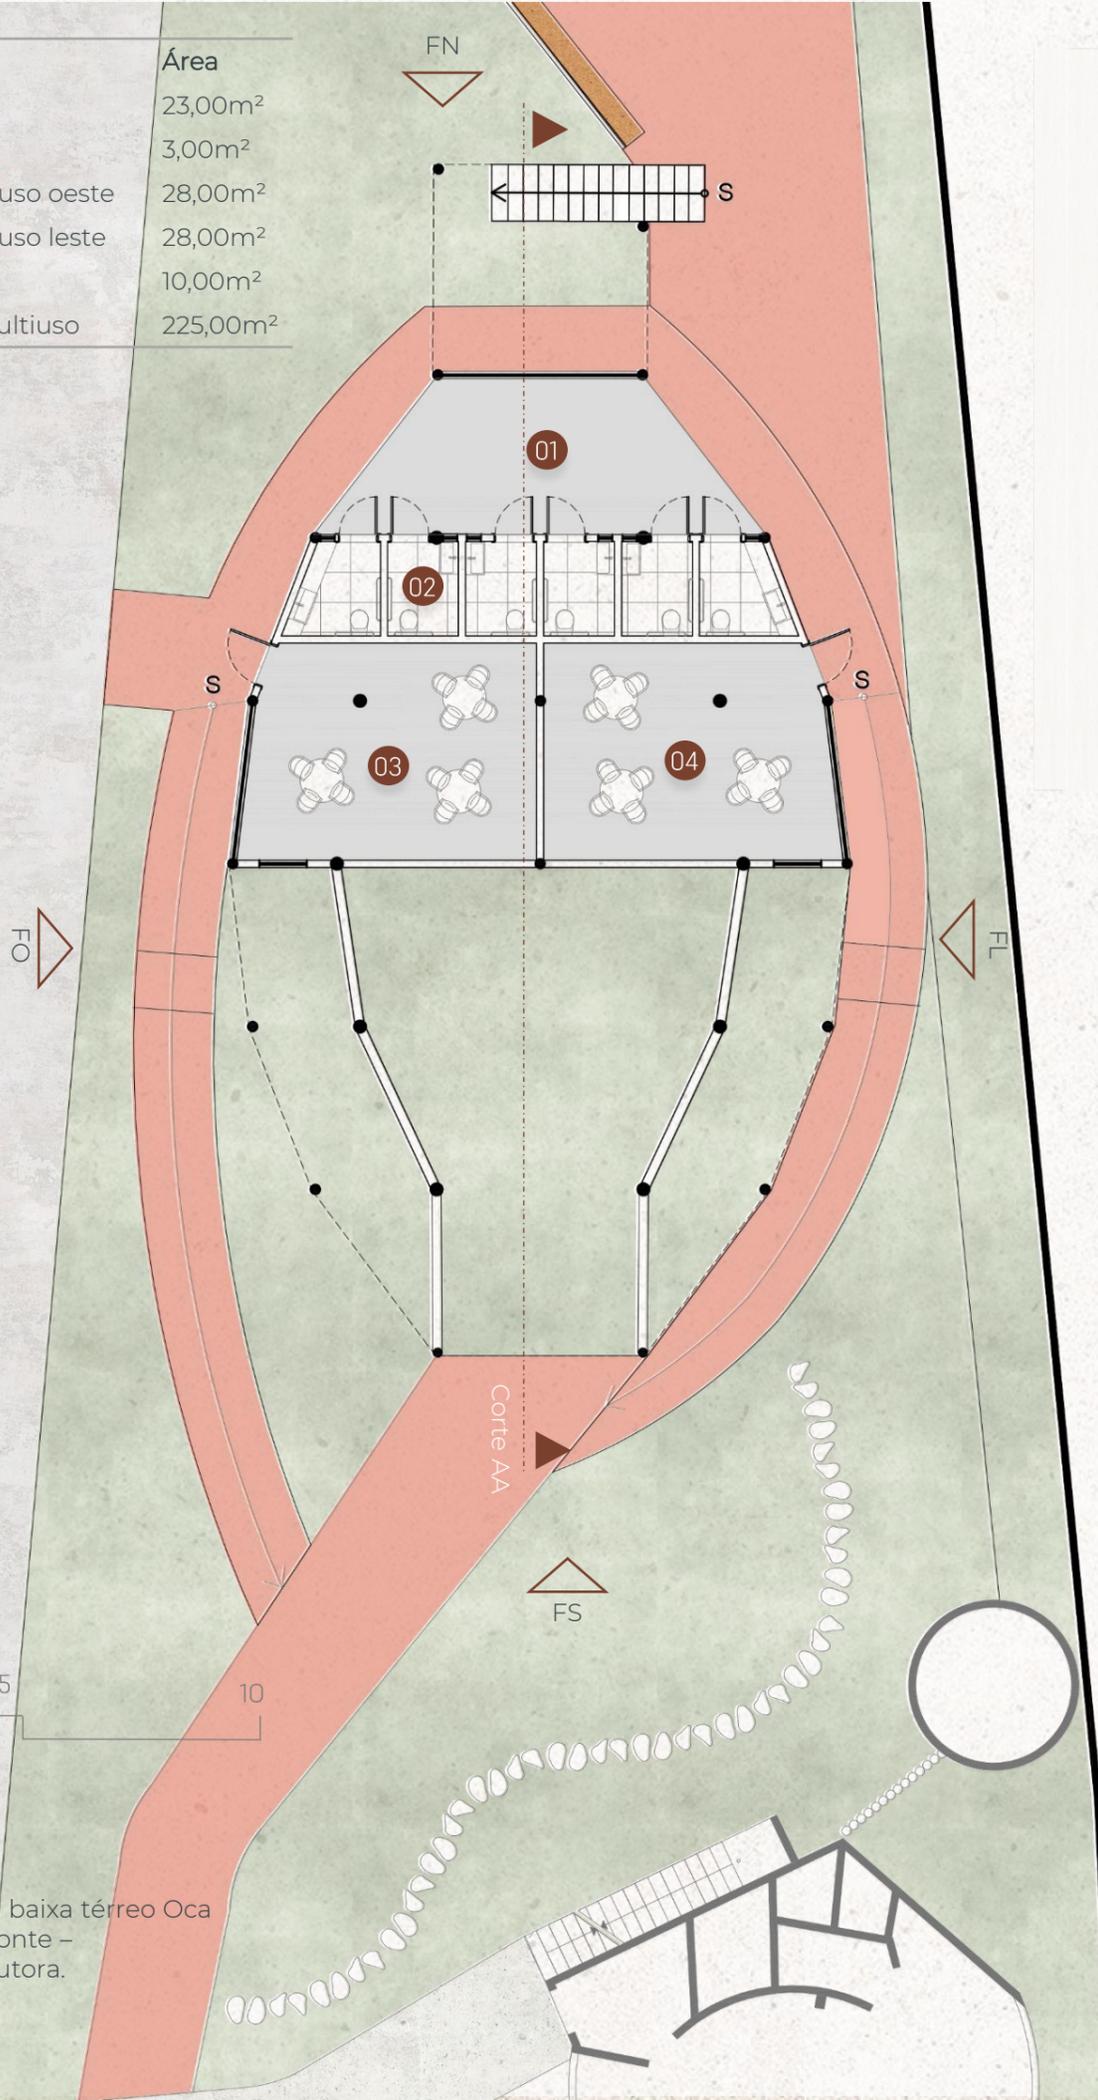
Planta baixa térreo Oca Zilma Saturnina Fonte –
